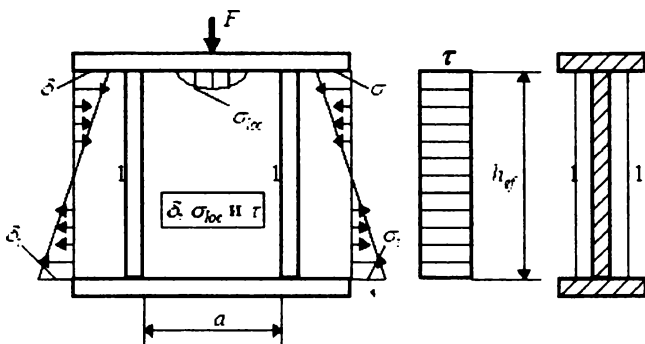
Схема балки, укрепленной поперечными основными ребрами жесткости (сосредоточенная нагрузка F приложена к сжатому поясу)
